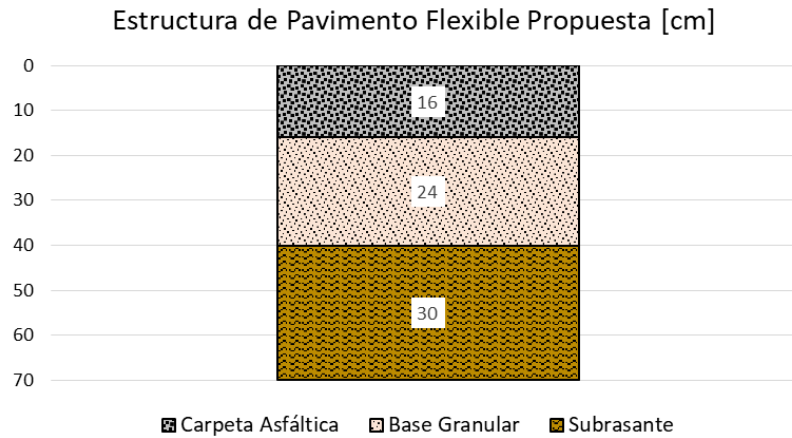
Estructura de Pavimento Flexible Propuesta
